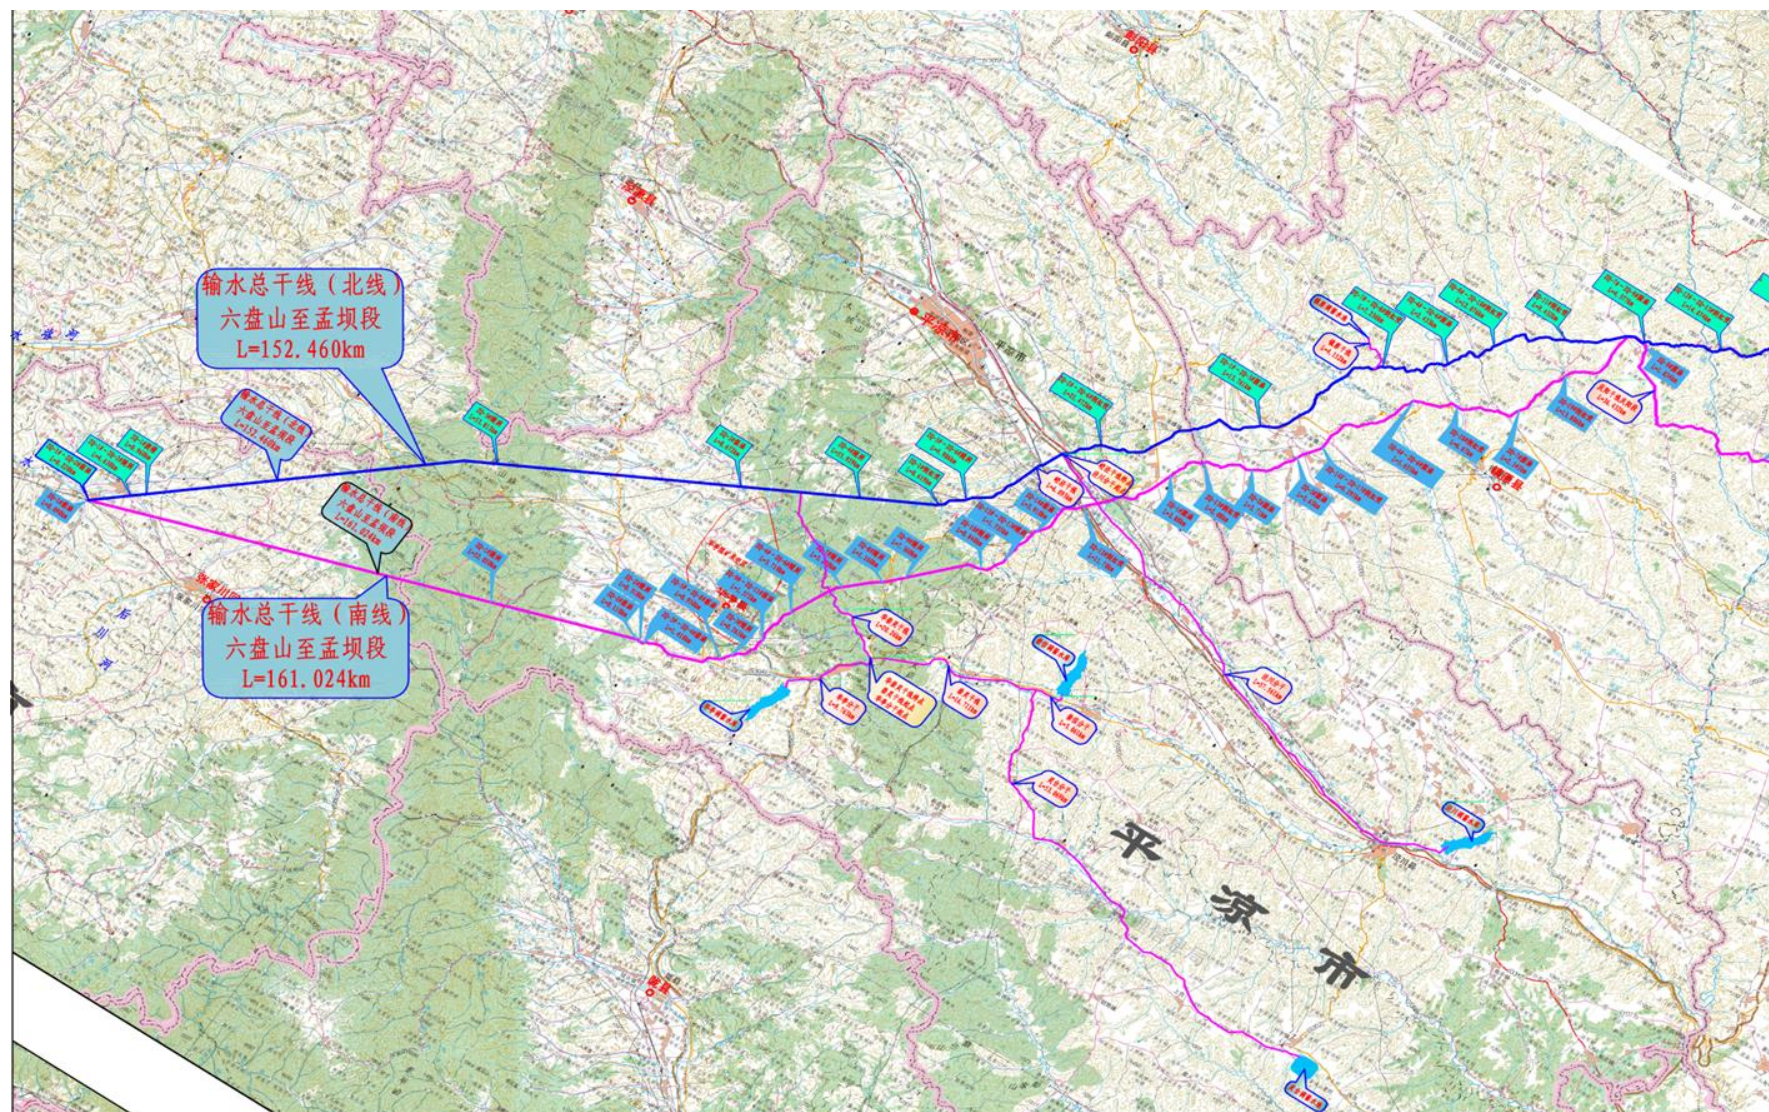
输水总干线六盘山至孟坝段平面布置图
